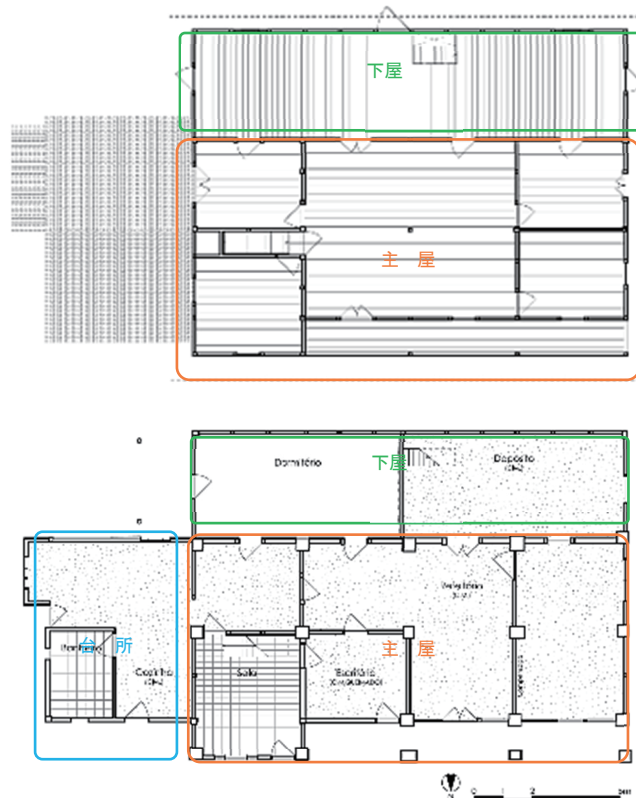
天谷家住宅現状図面(1・2階平面図、断面図)
